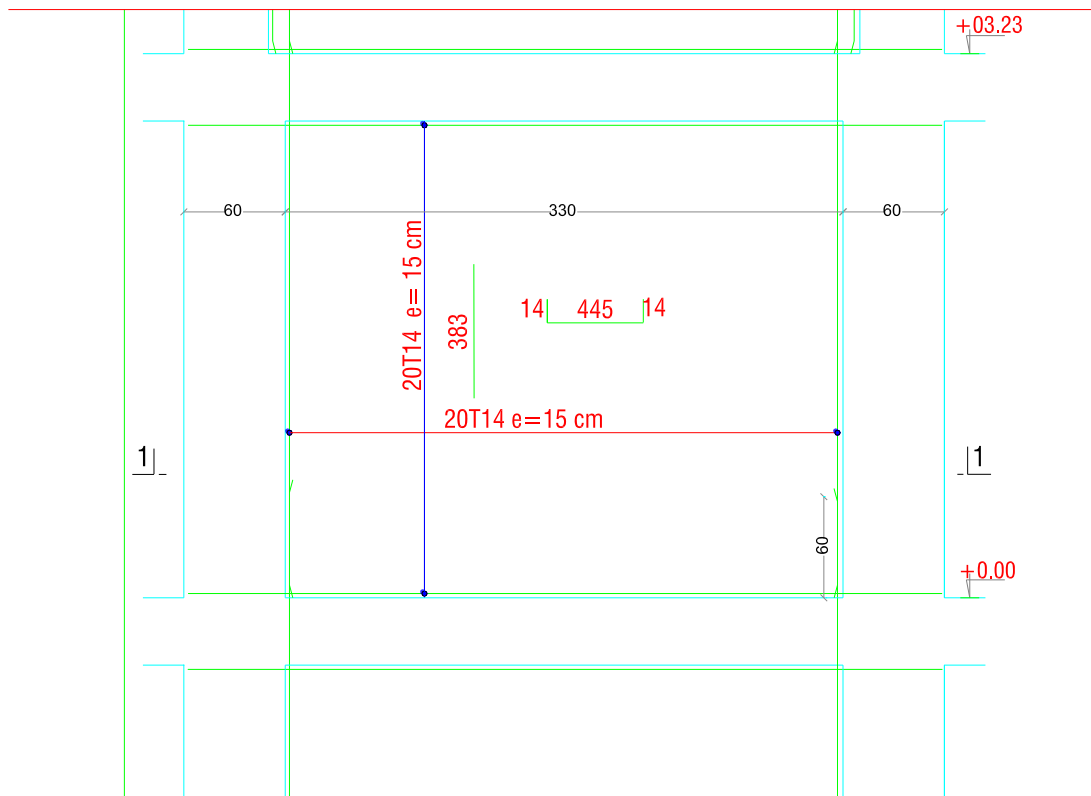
Coupe verticale de Ferrailage des voiles au niveau de RDC.
